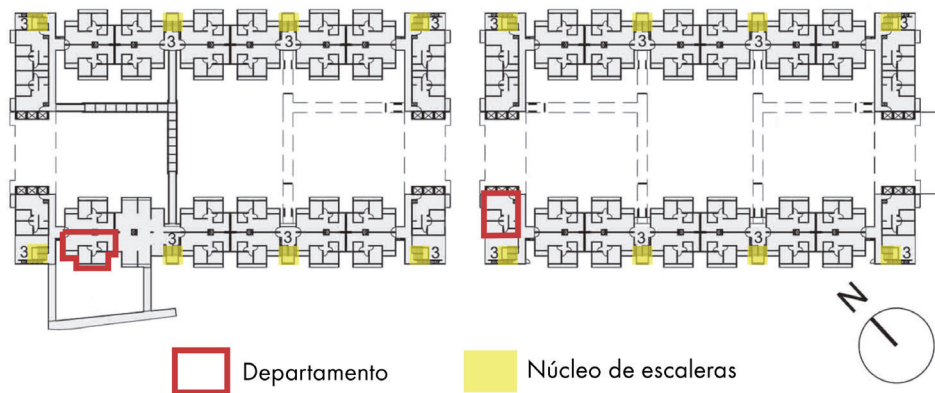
Plano arquitectónico de planta baja de bloques multifamiliares Heliópolis
